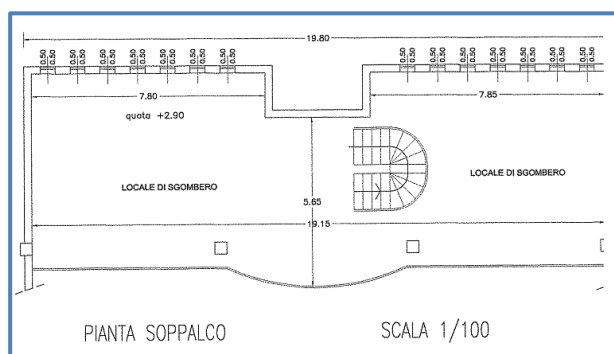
pianta soppalco - Tav. n°2 C.E. n°86/2005
